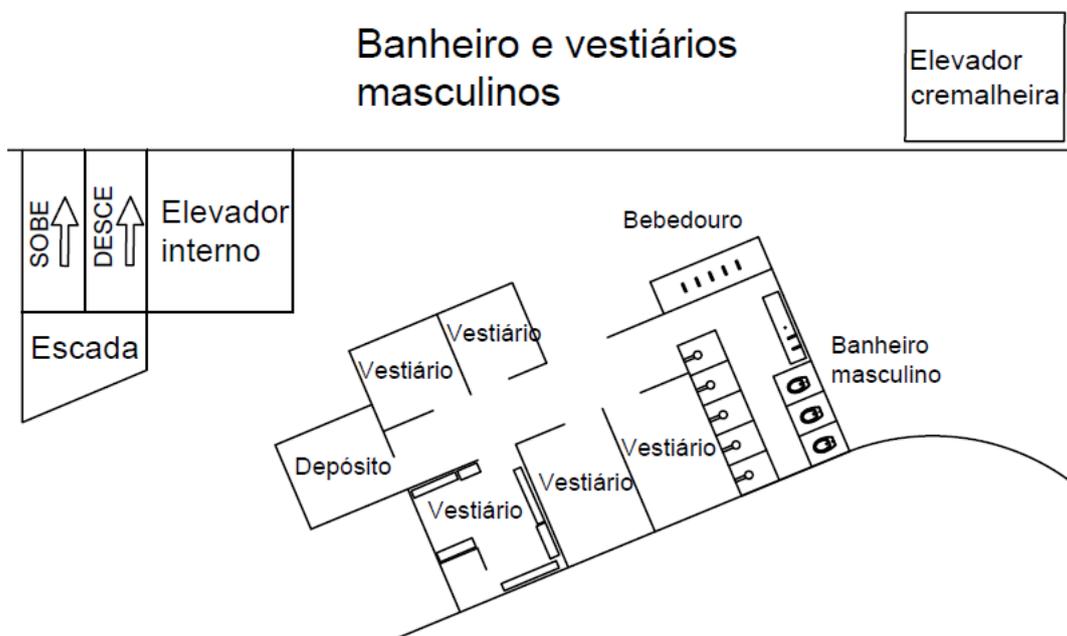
Croqui do canteiro de obras no primeiro subsolo. Fonte: Elaborado pelo autor.
